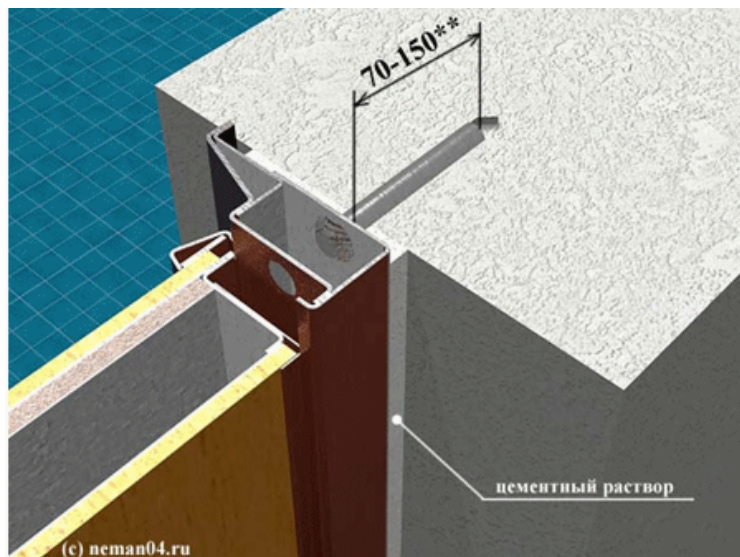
Схема установки металлической двери в проем железобетонной стены по типу А-2
